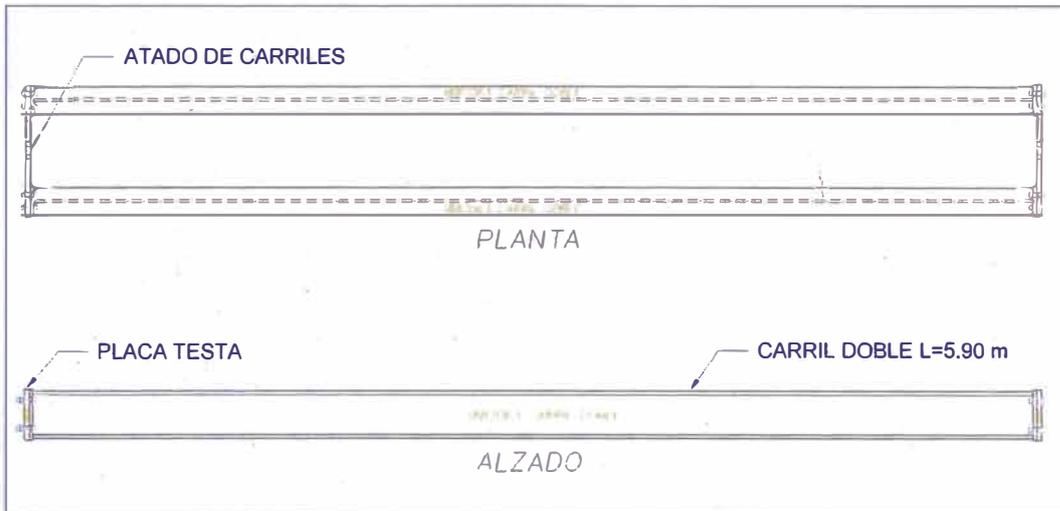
Planta y Alzado de Carril Doble L=5.90 m - Fuente: Elaboración Propia
